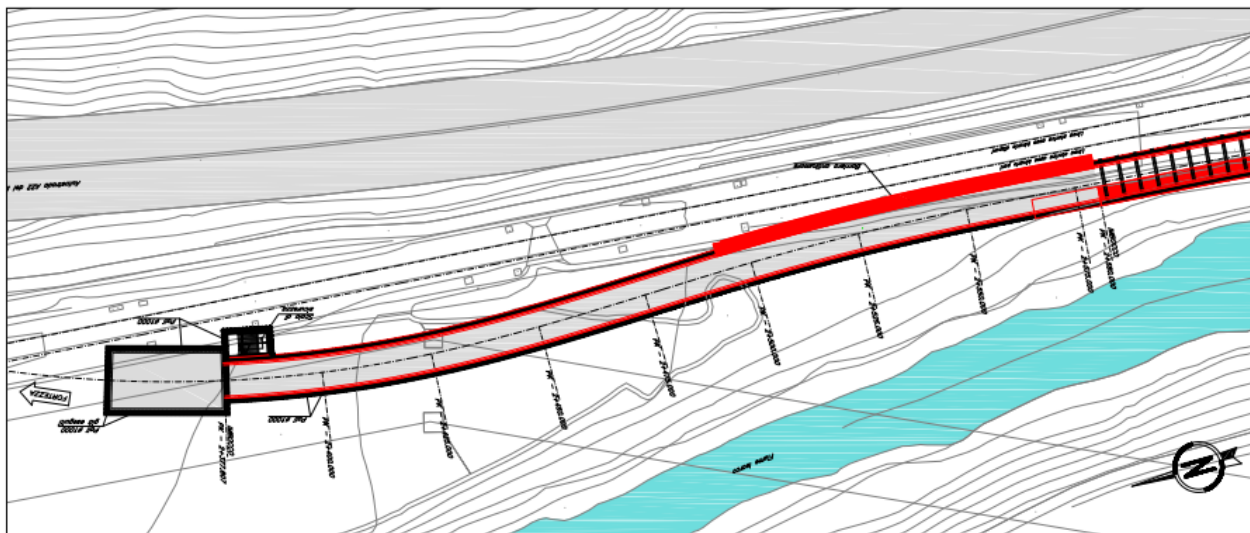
Progetto Definitivo - Planimetria dell'imbocco (Parte 2/2)
